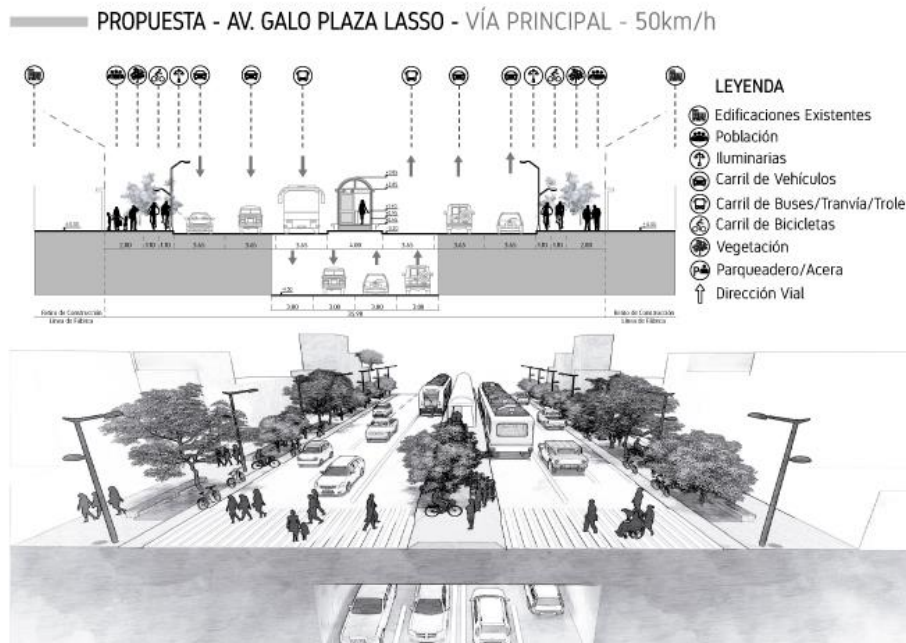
Propuesta del Plan Estratégico Urbano - Sistema de Movilidad - Reestructuración Vial
